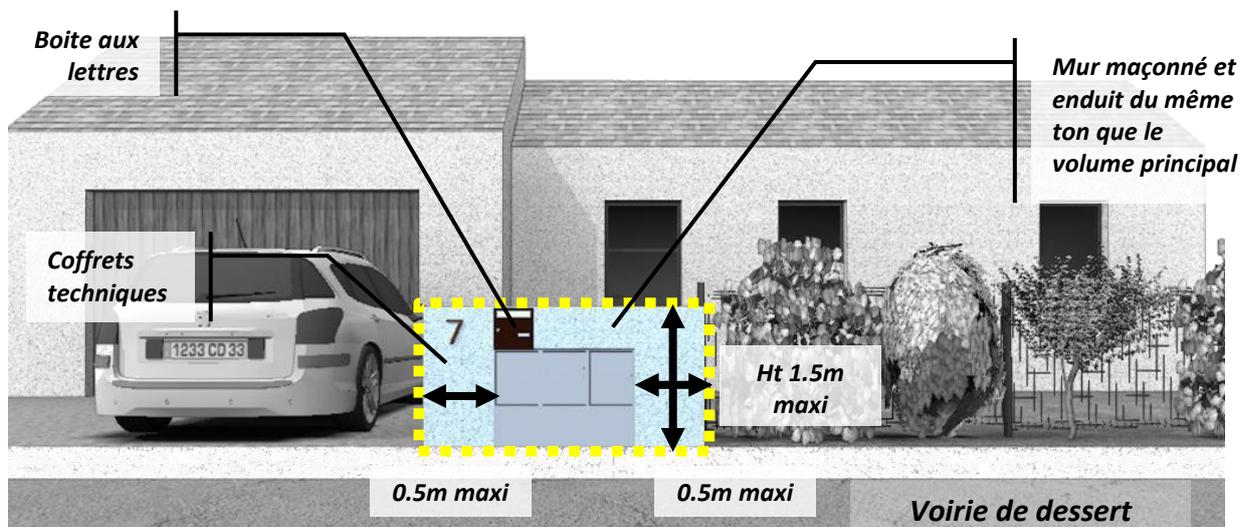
Maquette 3D du rendu concernant le muret maçonné autorisé pour habiller les coffrets et la boîte aux lettres
